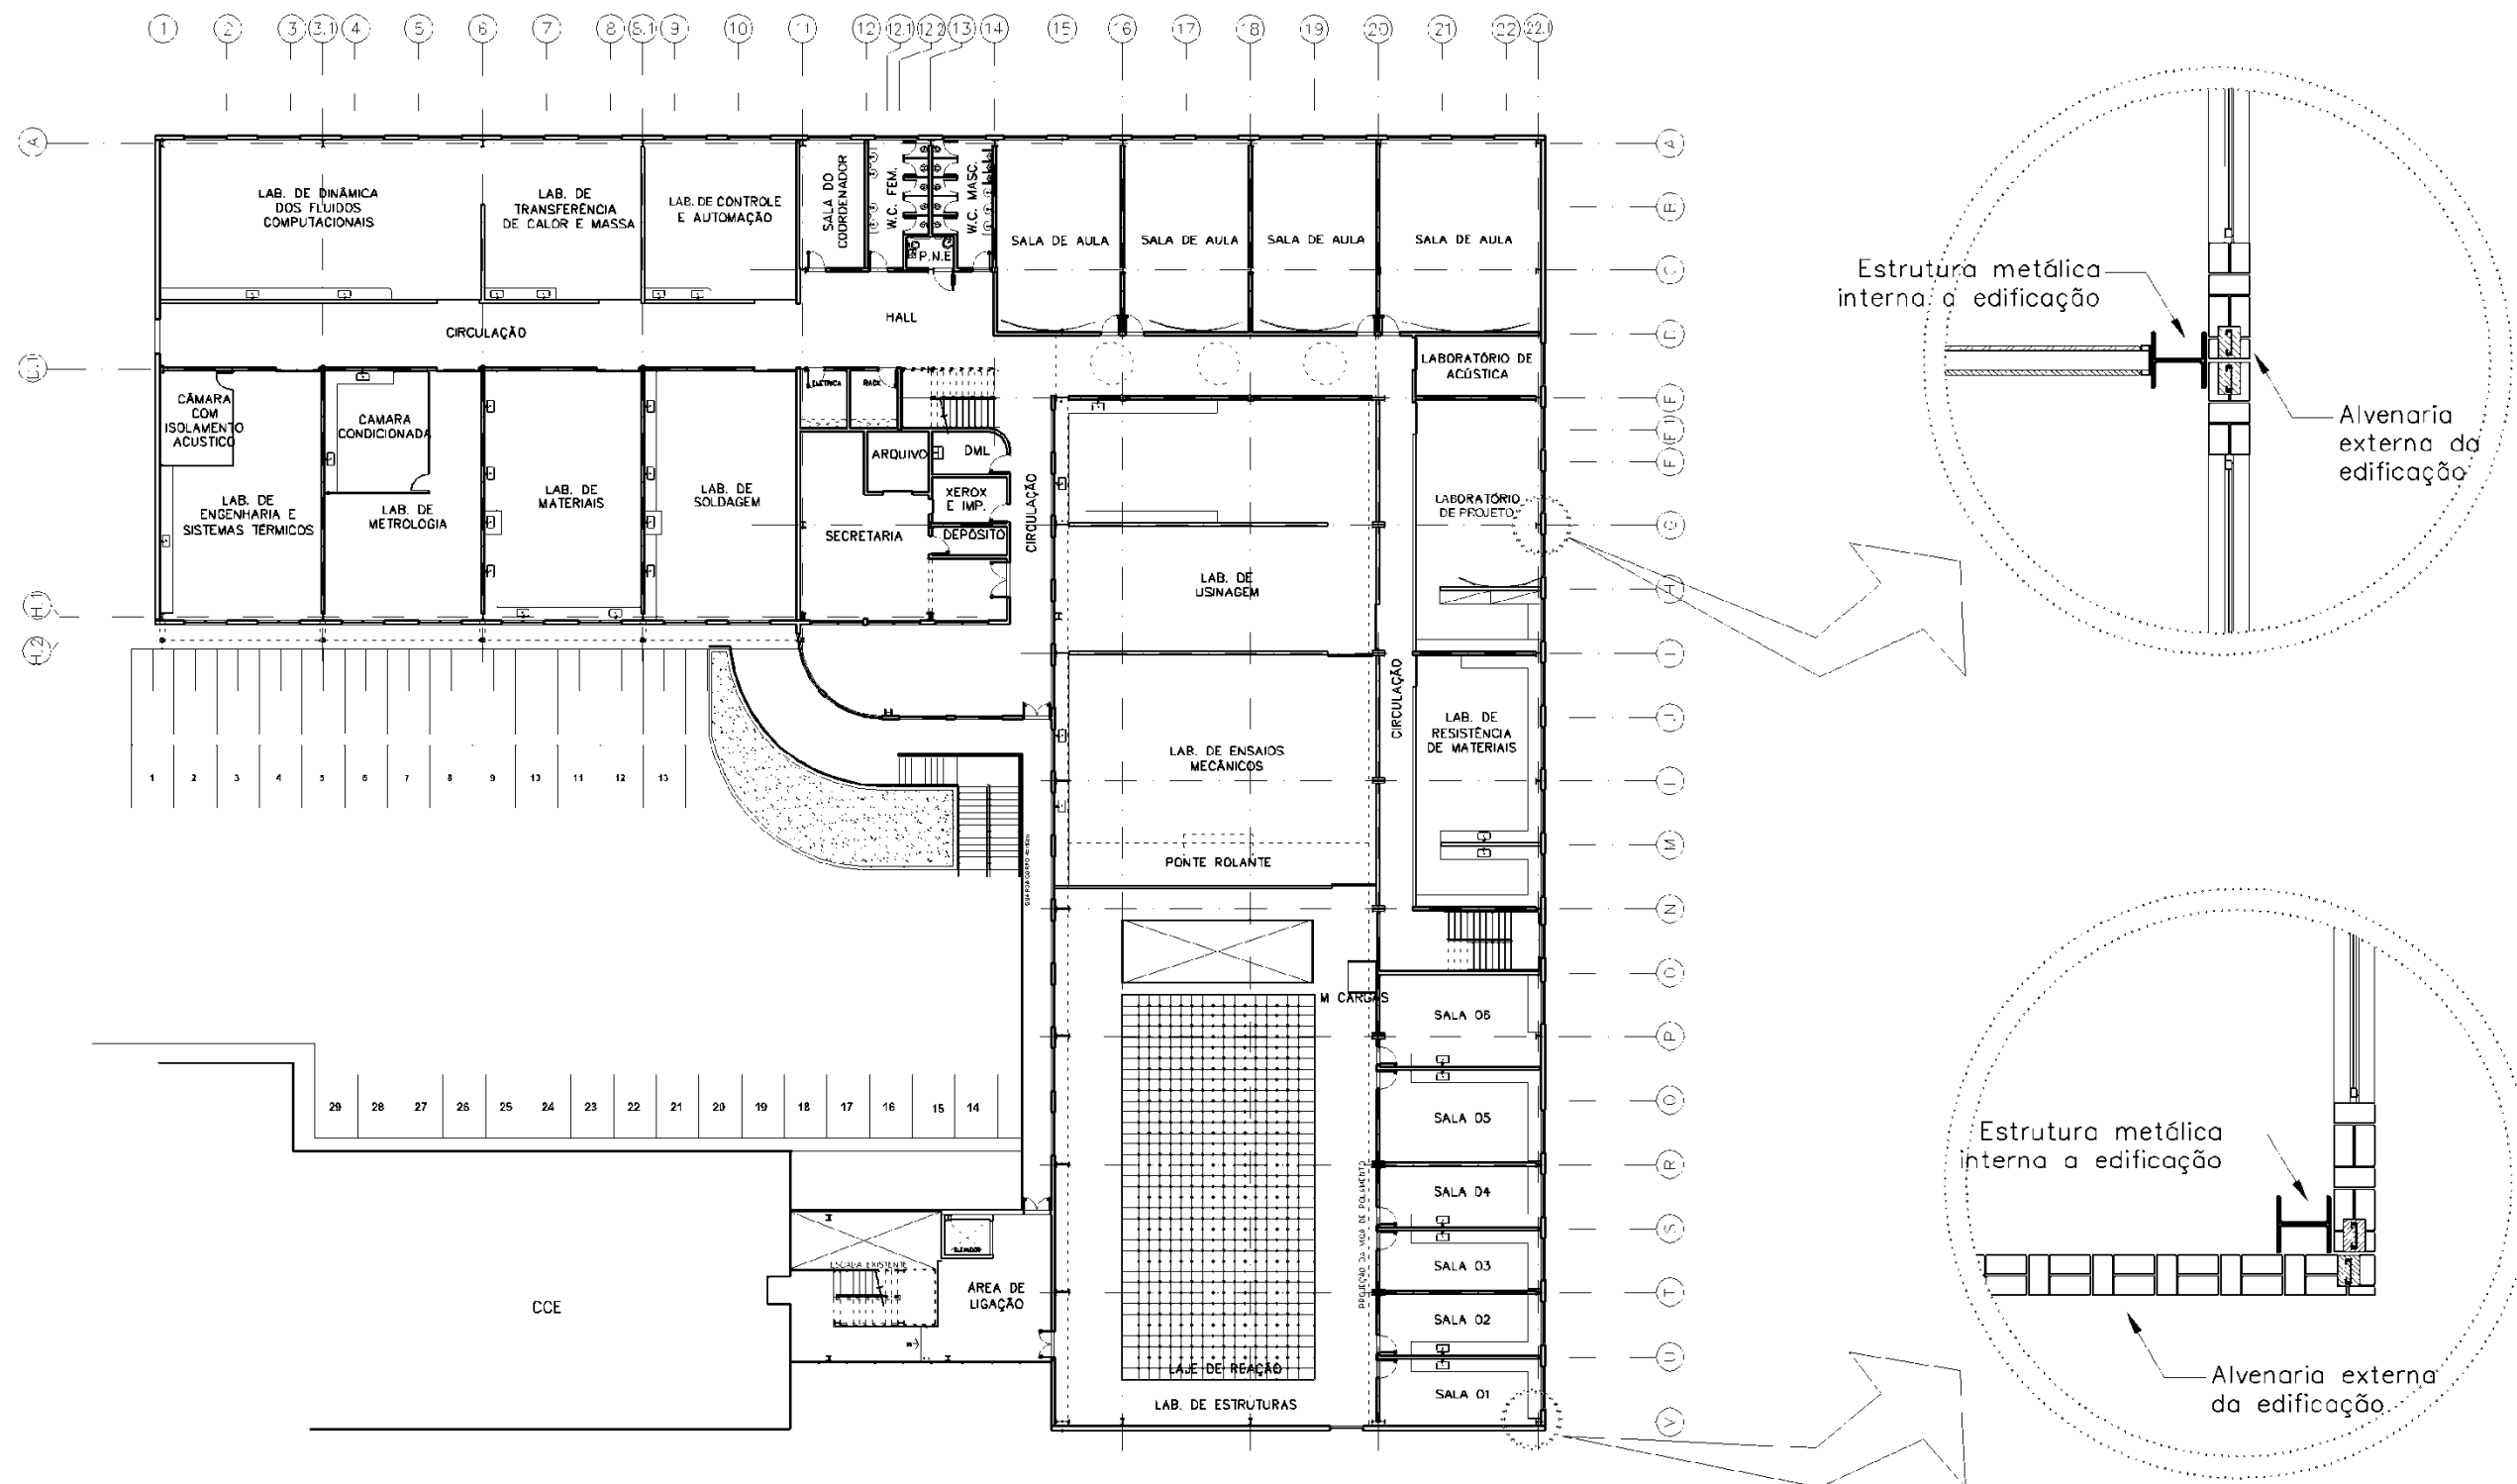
Planta do pavimento 01 com detalhe da alvenaria em relação à estrutura metálica.
